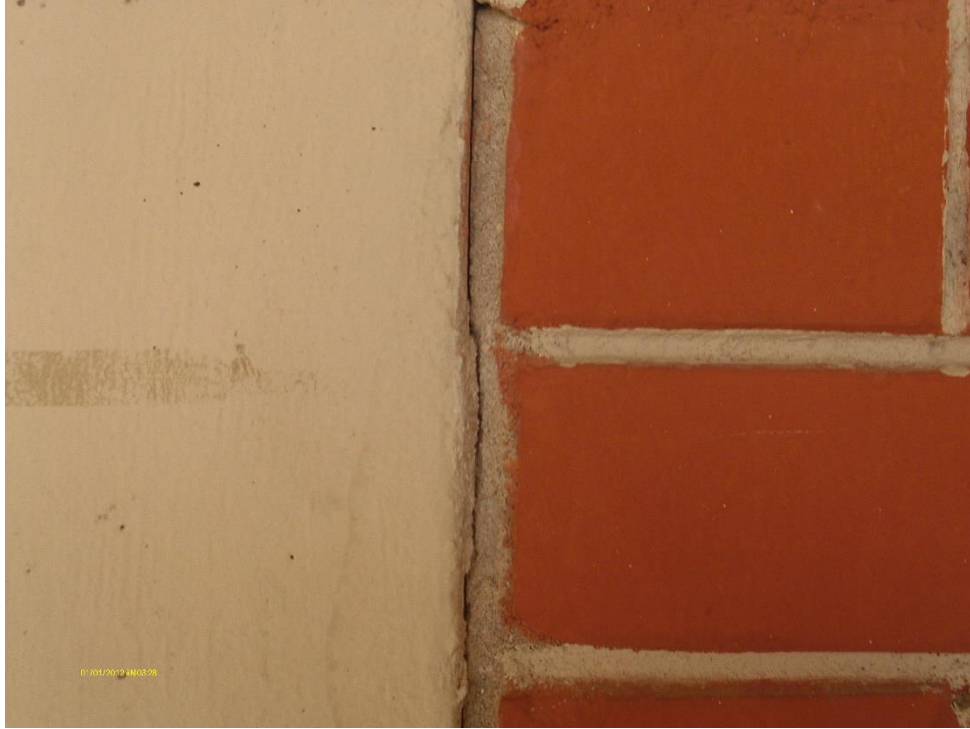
Fissura entre painel de alvenaria e pilar.
